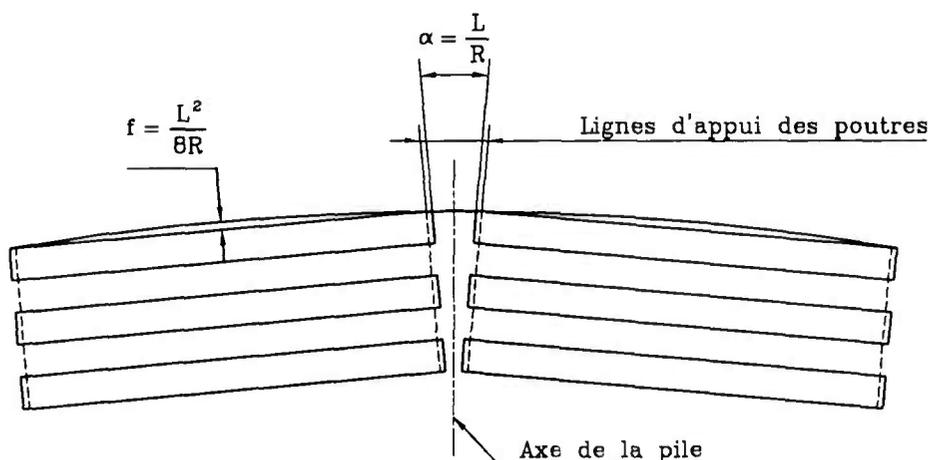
Pont courbe : disposition des poutres sur un appui.
